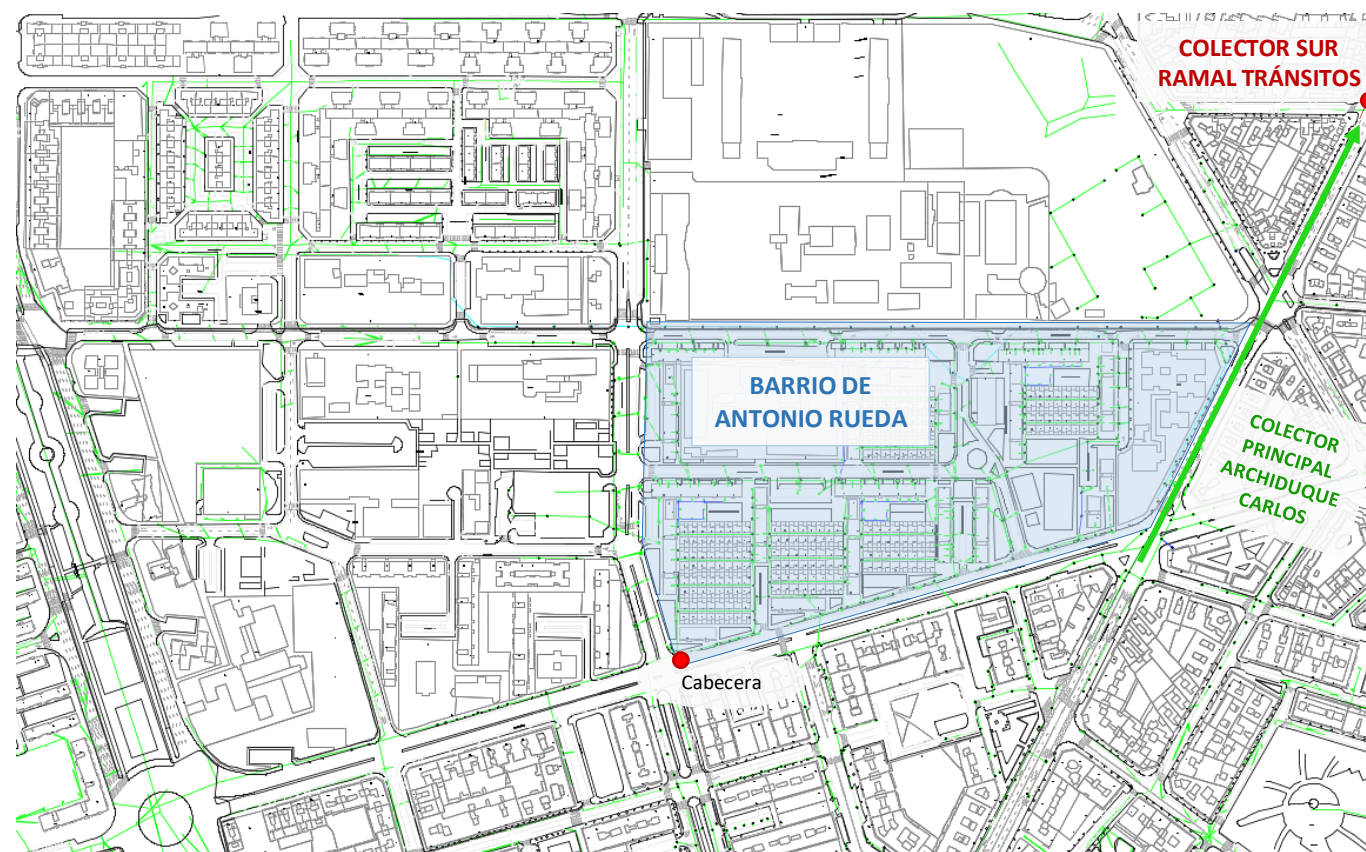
Esquema en planta para el estudio de la opción B. Fuente: Elaboración propia.
